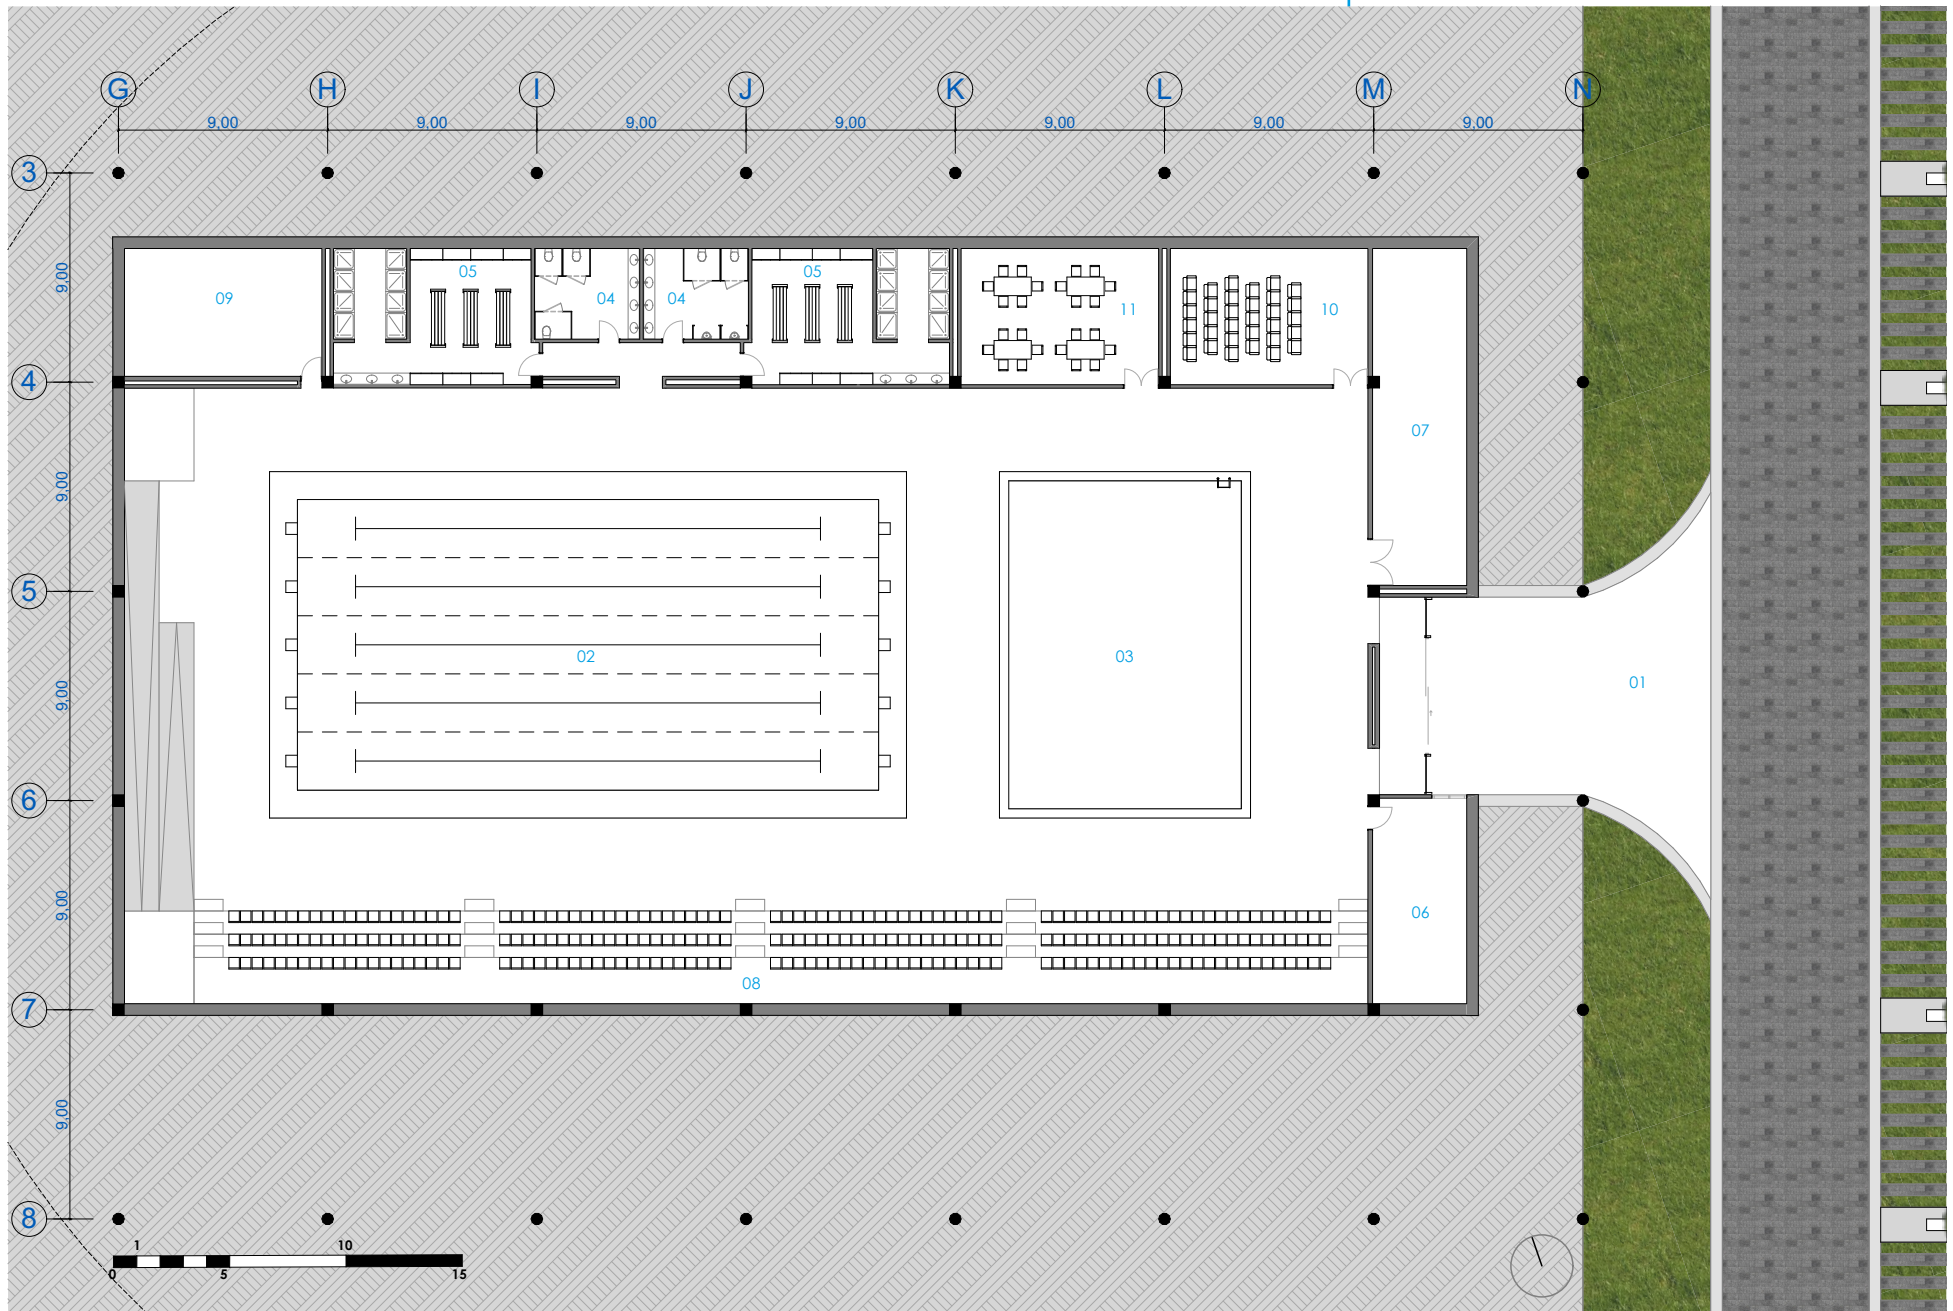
| Planta subsuelo n. -3.00 m, bloque A, proyecto arquitectónico. | Elaboración: Propia.
